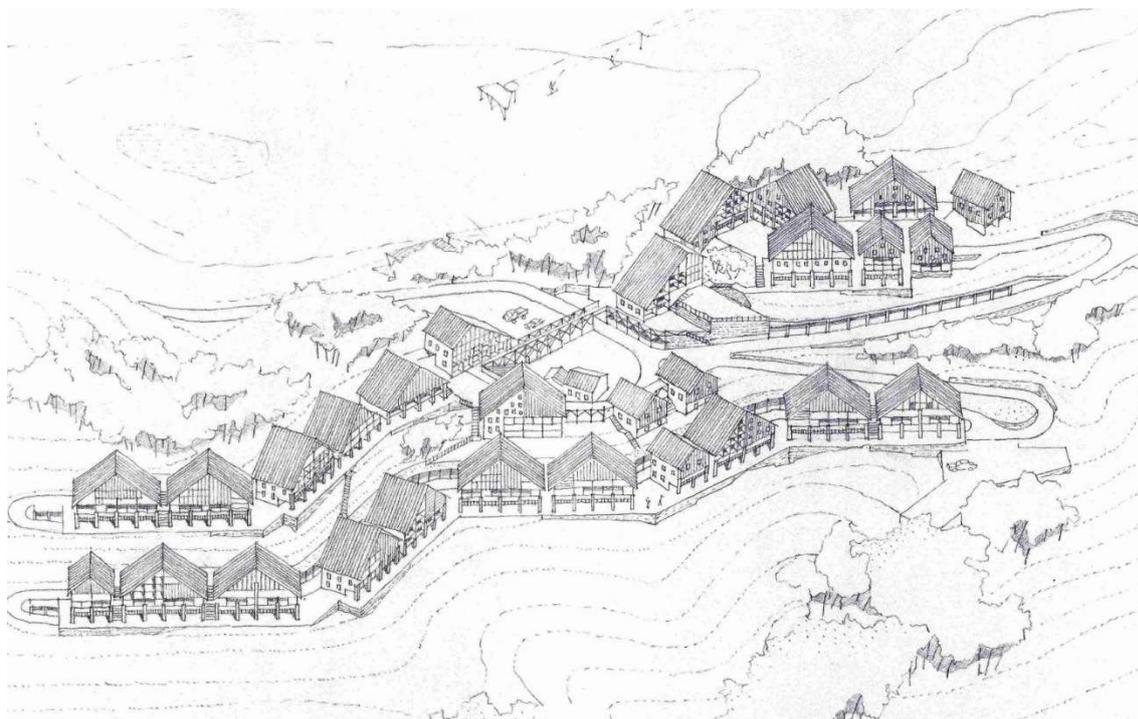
Prospetto tridimensionale del nuovo borgo Stalle Lunghe.
